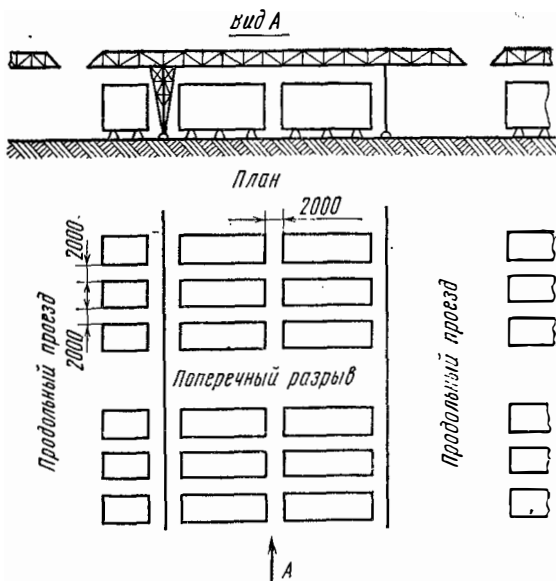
Планировка склада для группы пакетных штабелей при укладке козловым краном
